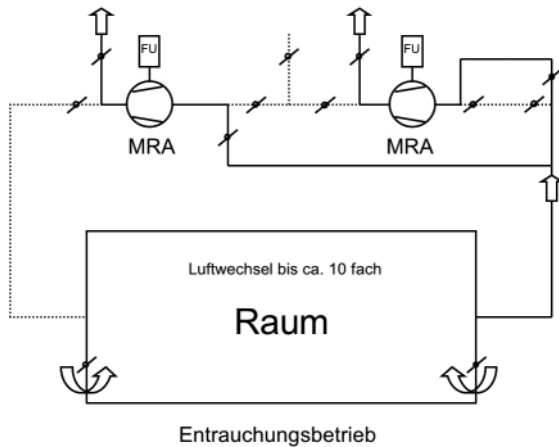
Anlagenschema einer Lüftungsanlage im Entrauchungsbetrieb mit einer Entrauchungsleitung (Lüftung - Abluft)
